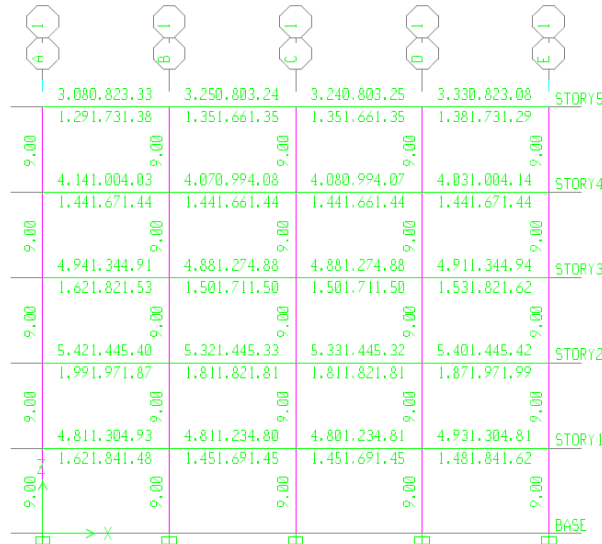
Área de acero en cm<sup>2</sup> para vigas y columnas P5 Caso 1, Fuente ; El Autor
